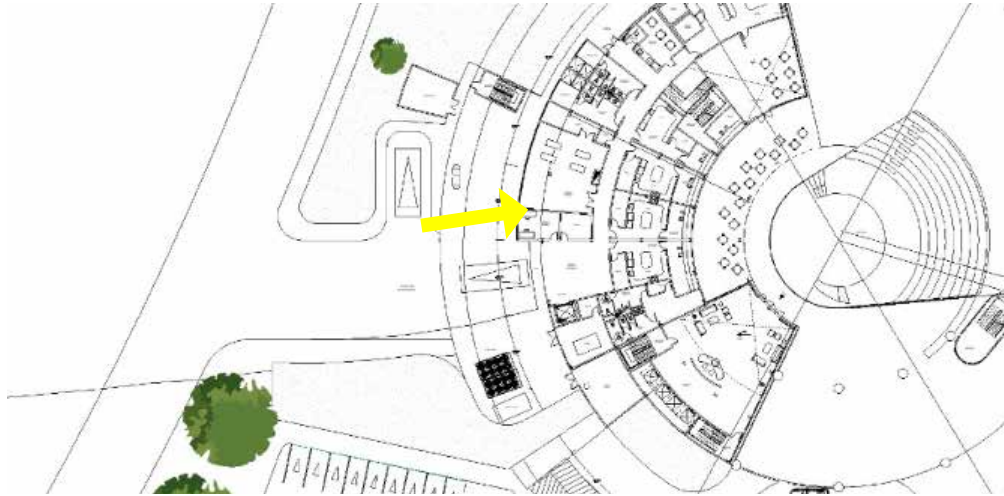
Plano de señalización de acceso de servicio. Fuente: Plano Planta Baja (2019)
